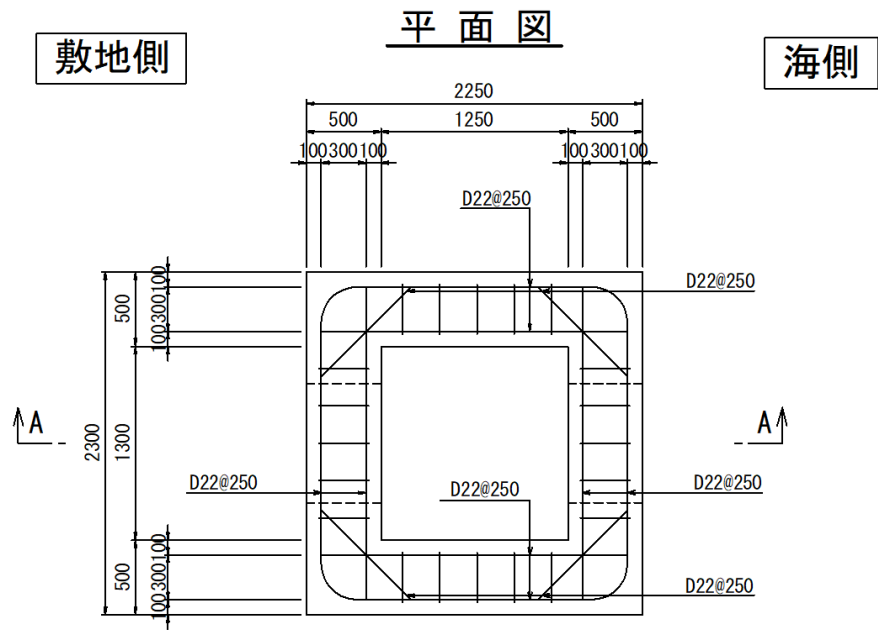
(3) 概略配筋図 (集水桝 (屋外排水路逆止弁⑦))
